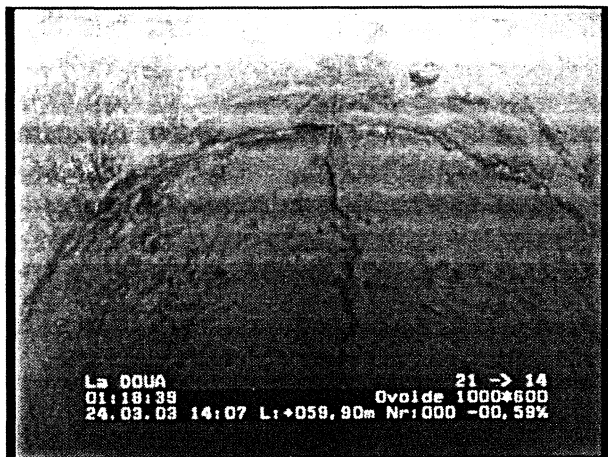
\_4a, N° cassette: 1, 01:18:34
